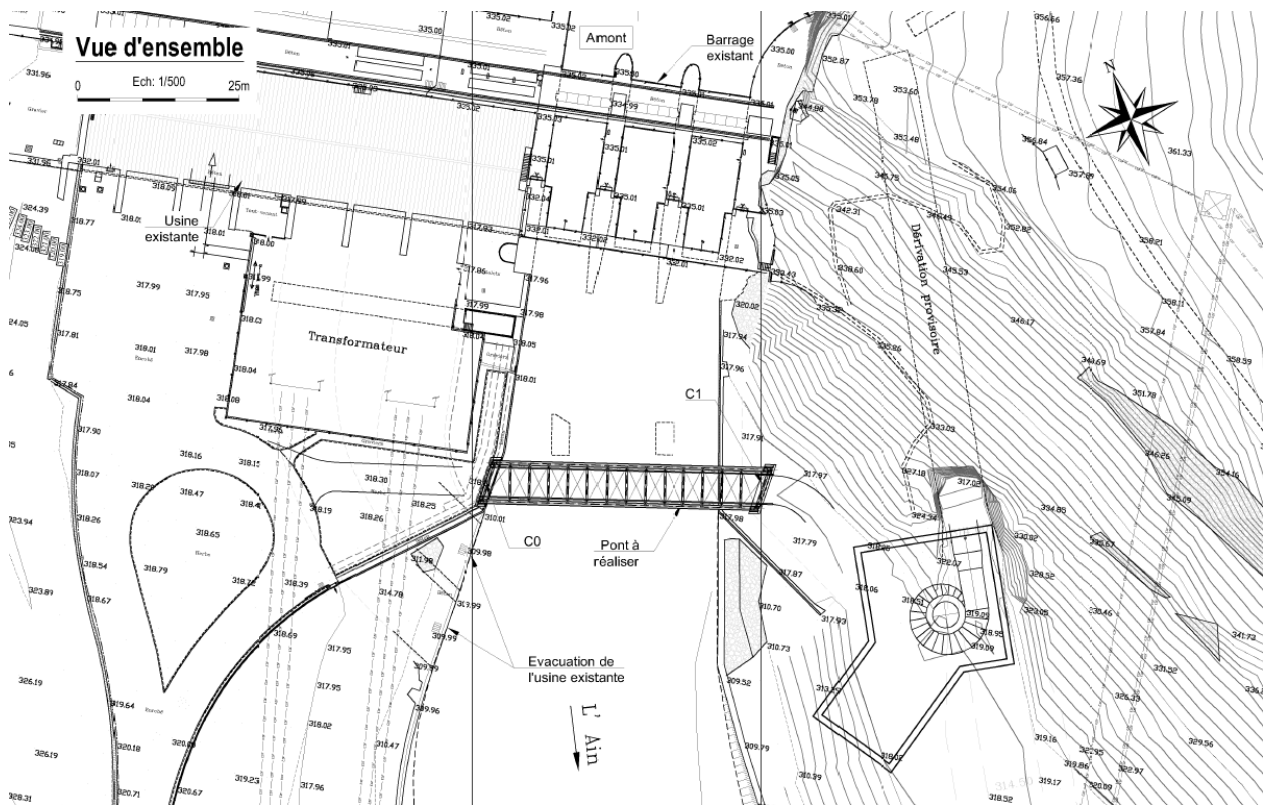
Plan d'implantation du pont définitif sur l'Ain
